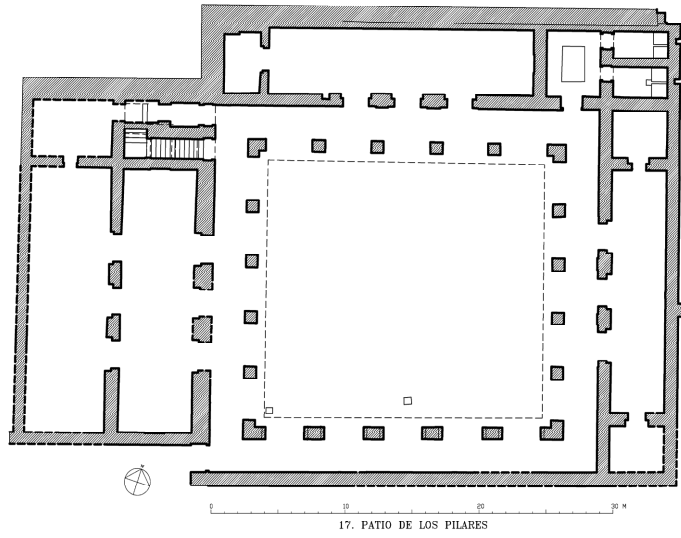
Planta del edificio del Patio de los Pilares de Madinat al-Zahra'
